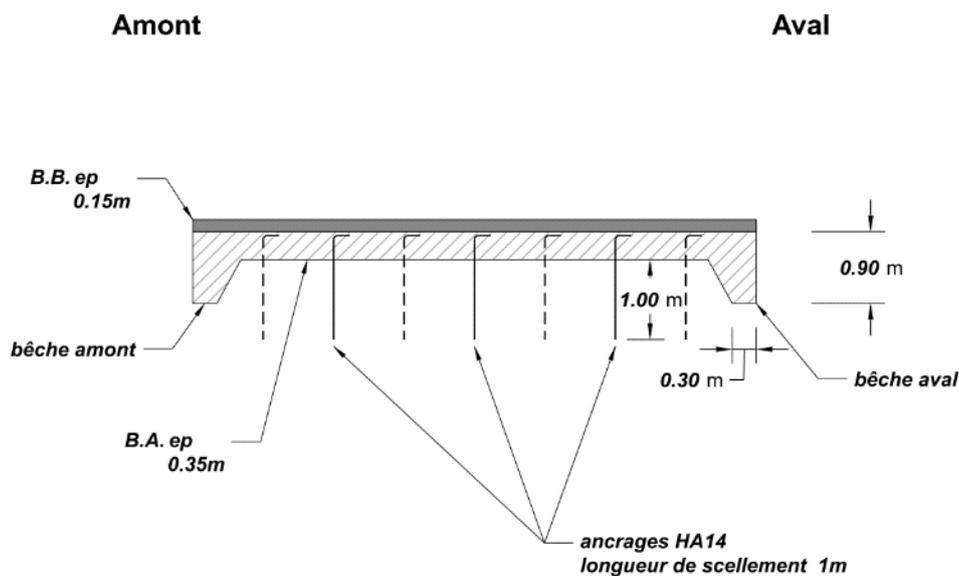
Coupe amont-aval de la dalle en béton sous la RN106 au droit du barrage
